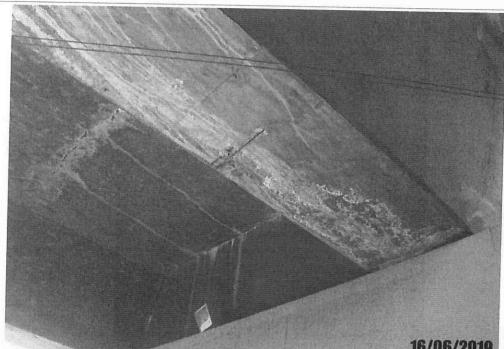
Detalhe de eflorescência e armadura exposta na viga principal e face inferior da laje do tabuleiro.
